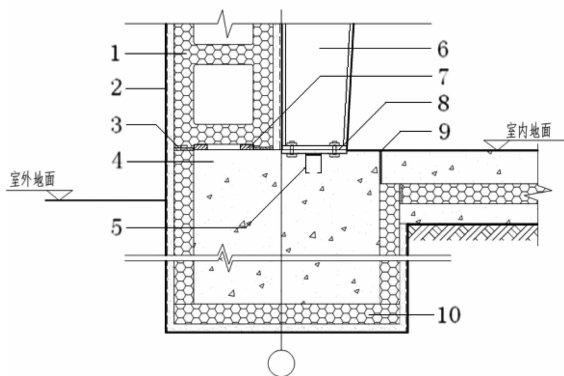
~ 5 基础地梁与墙体节点构造
